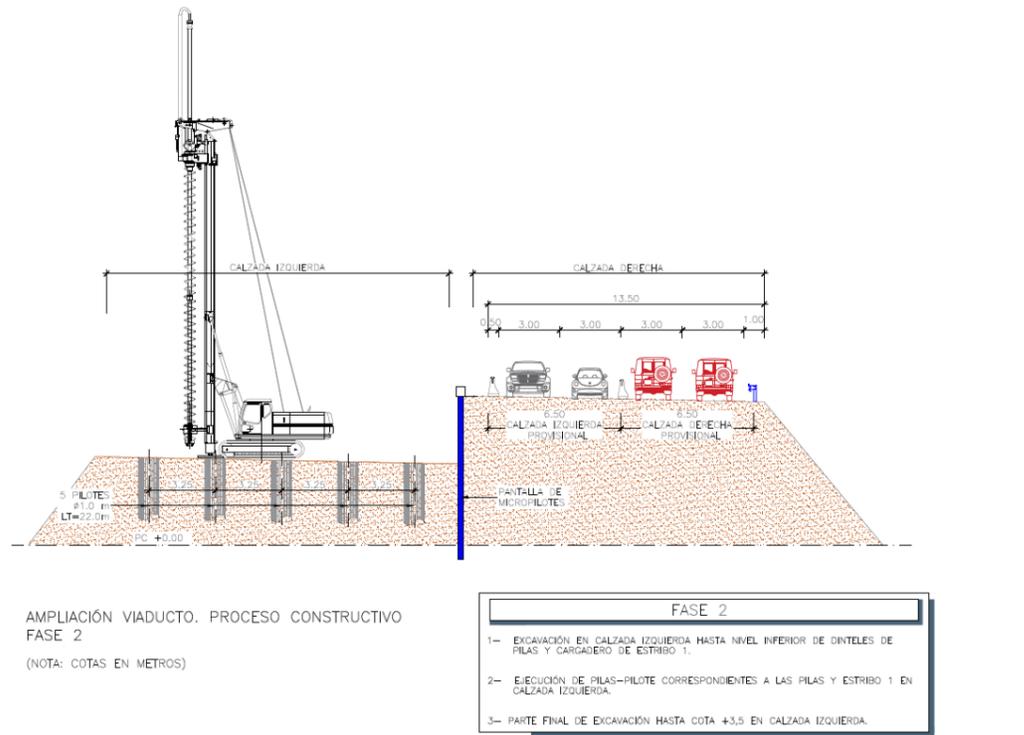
Proceso constructivo de la ampliación de vanos. Fase 2. Construcción de pilas-pilote.
